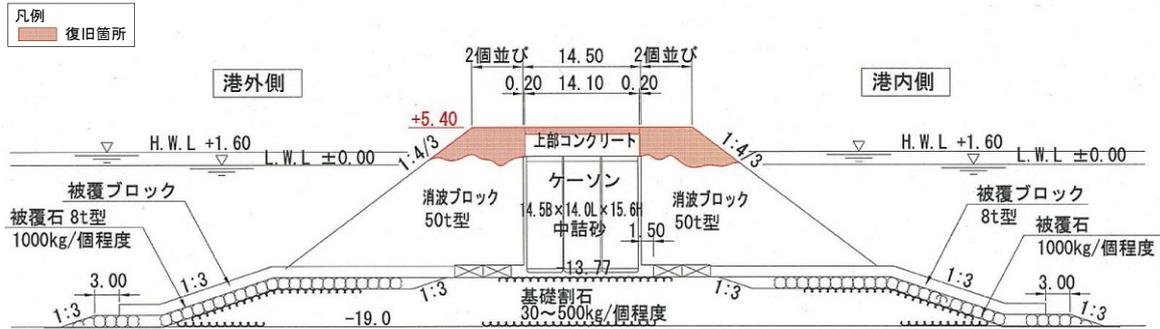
仙台港区\_外港地区\_沖防波堤の断面図 (堤頭部) (復旧後)
